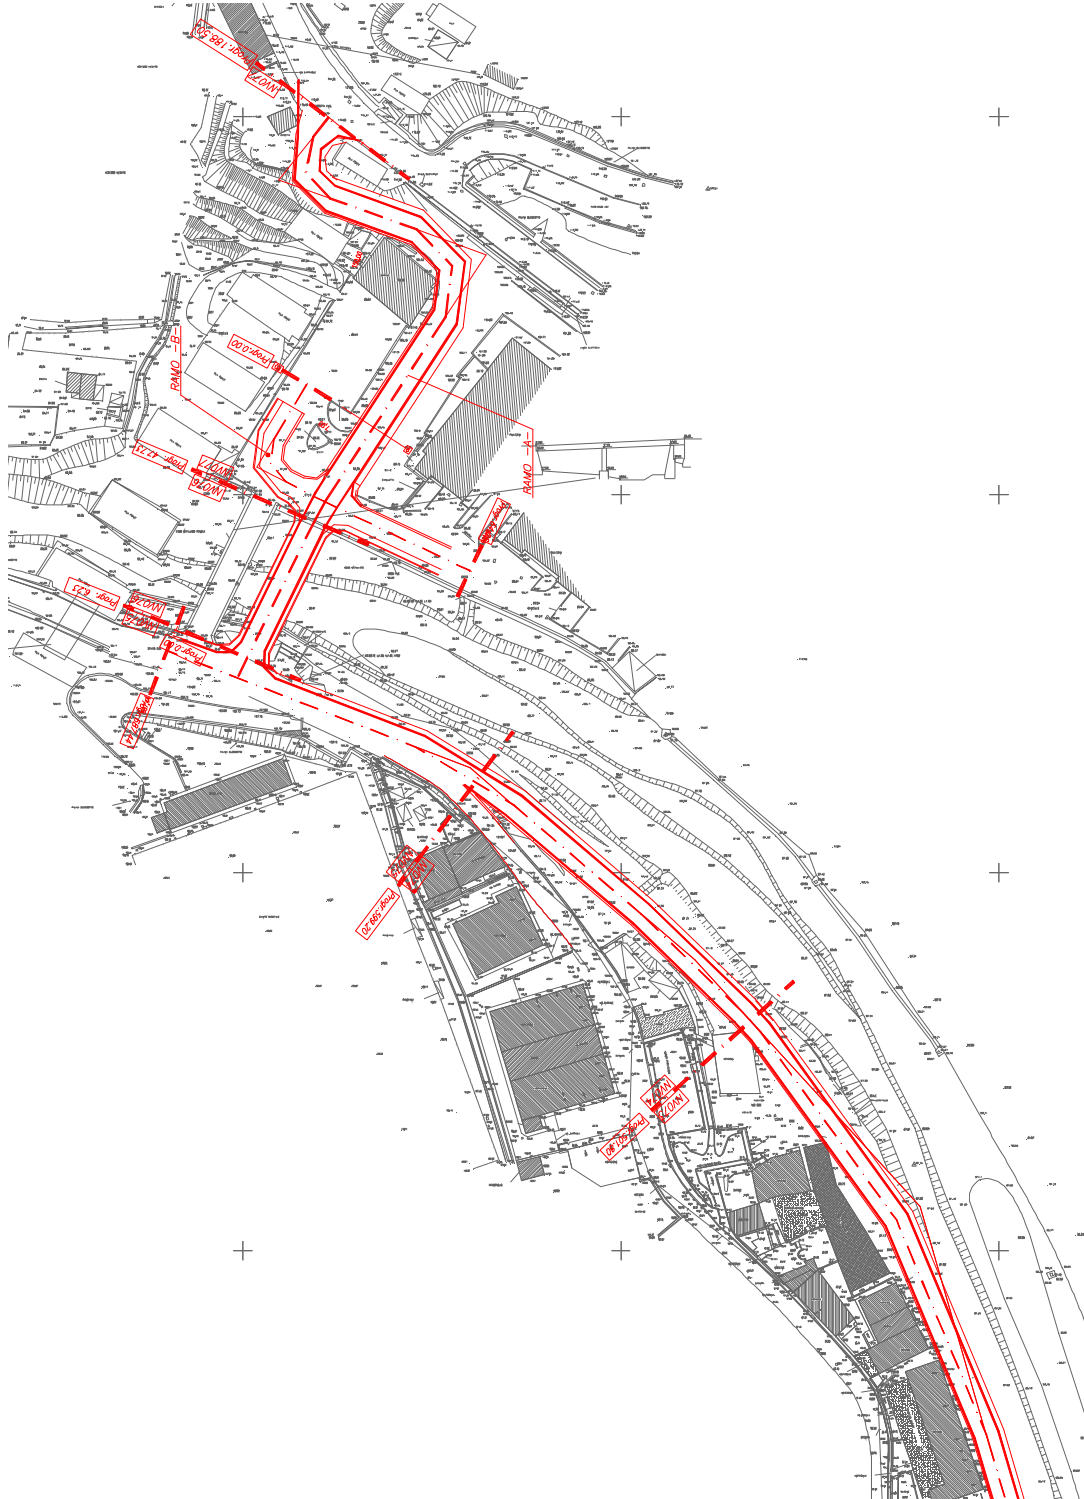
Planimetria Progetto Esecutivo approvato 1di 2
